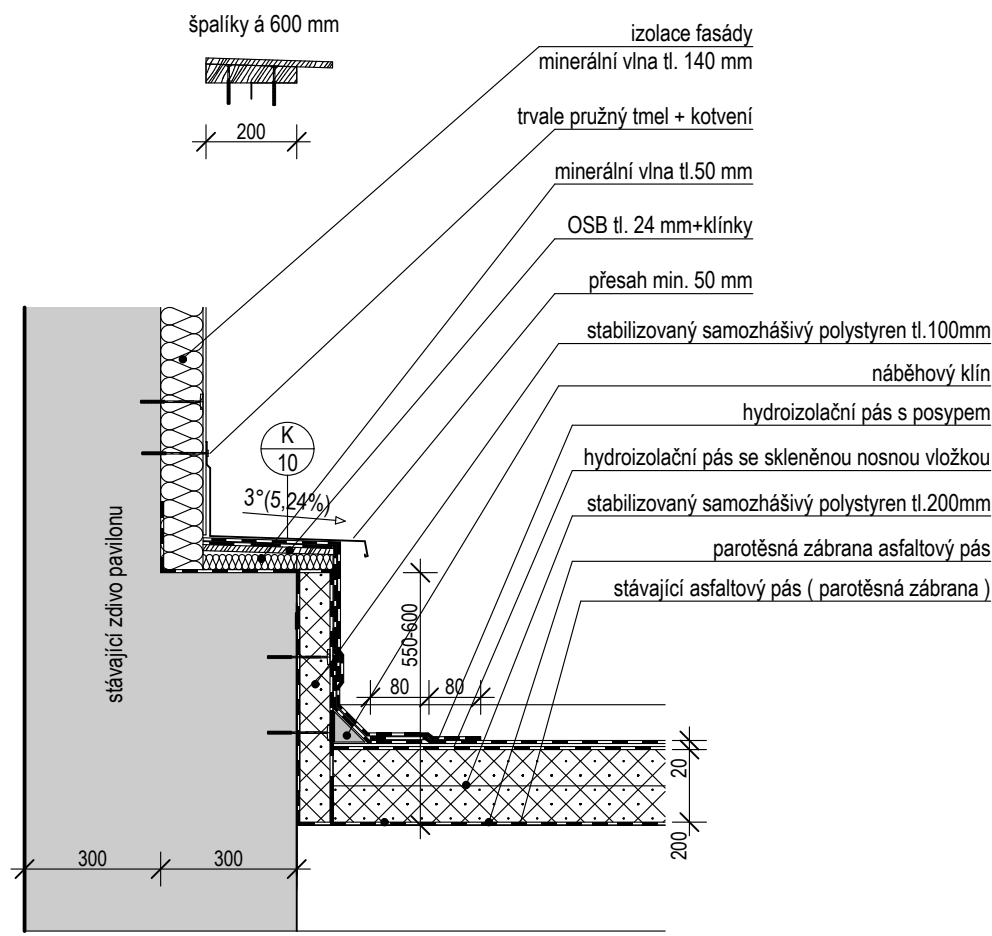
DETAIL E - NAPOJENÍ STĚNA - STŘECHA
